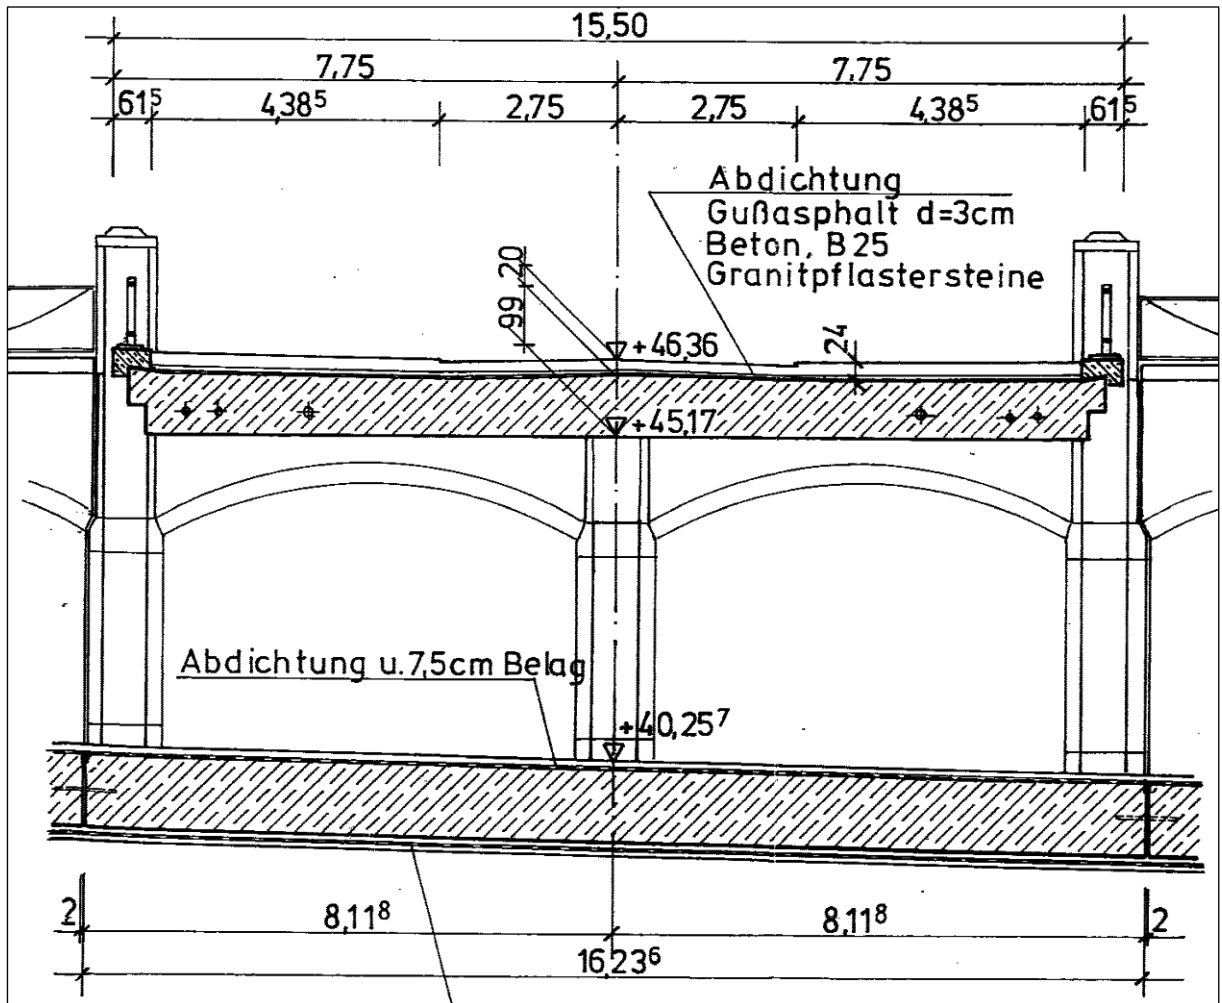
Schnitt I-I (Brücke Hagener Alle) – Segment 4
